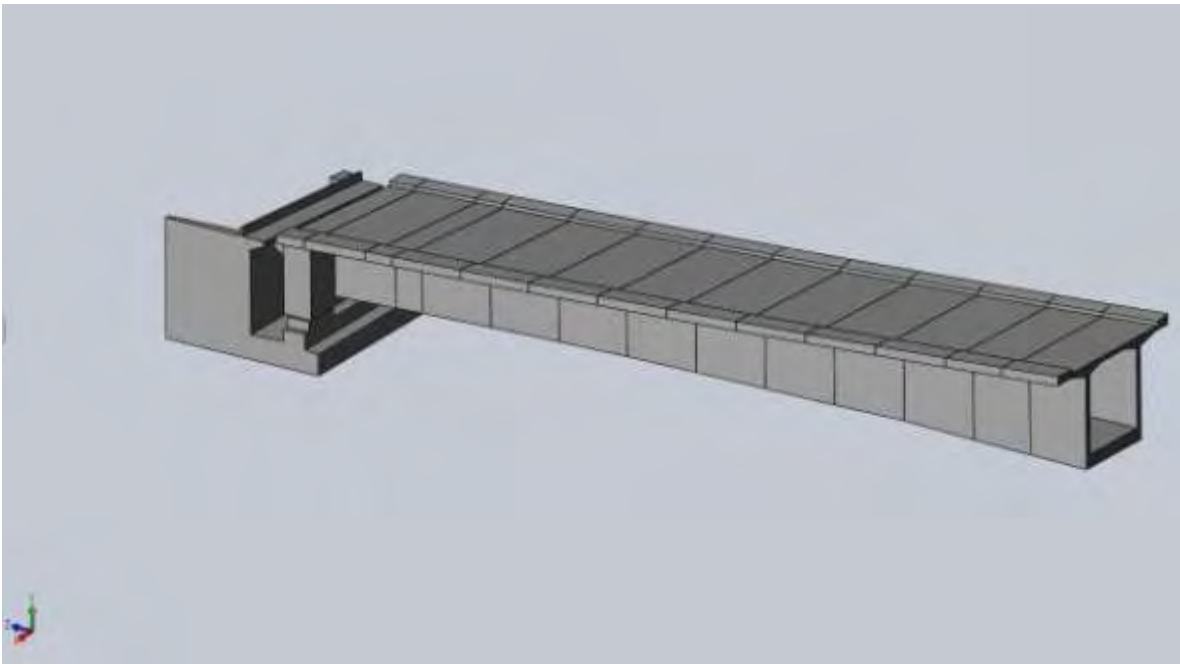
Συναρμολόγηση τελικού Assembly, στάδιο 2
